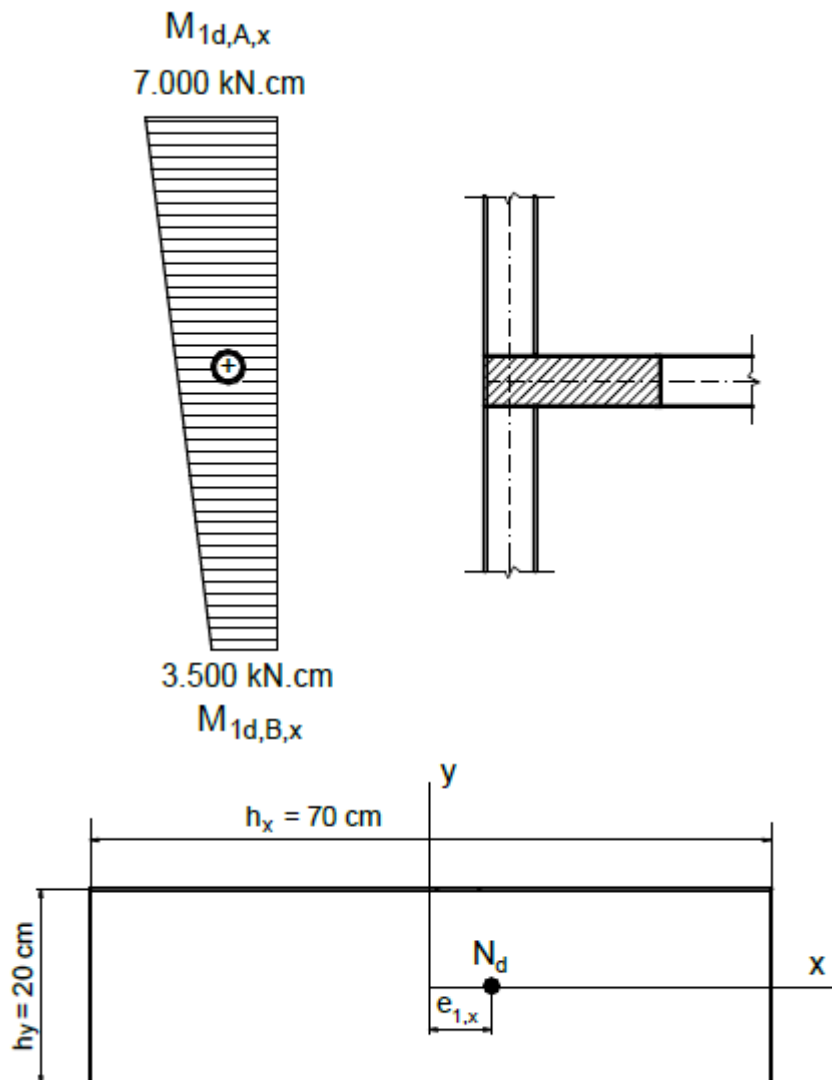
Dimensões da seção transversal, arranjo estrutural do pilar na planta de fôrma e momentos fletores de primeira ordem na direção x.
